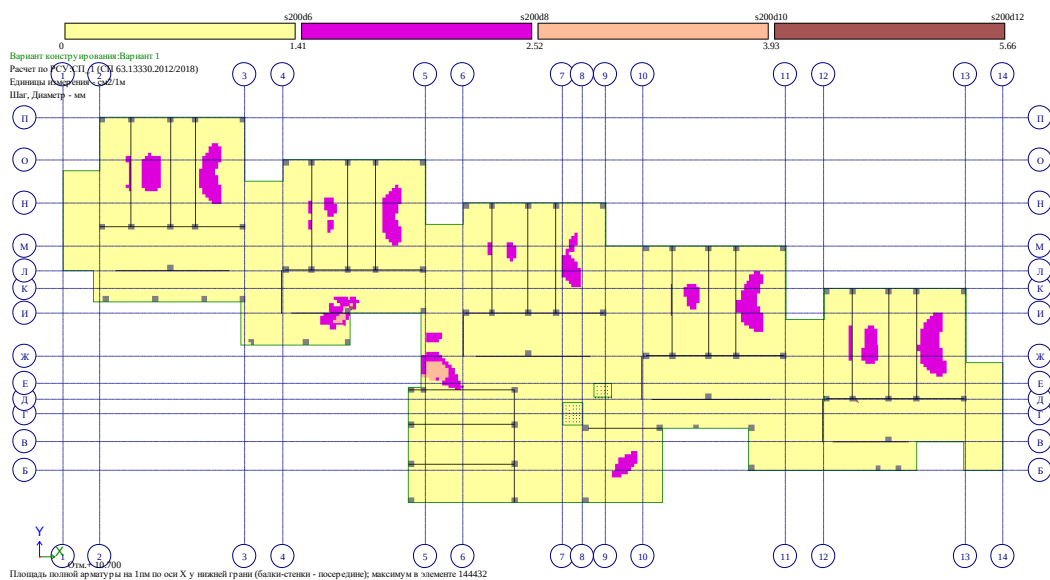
Схема армирования плиты перекрытия у нижней грани
